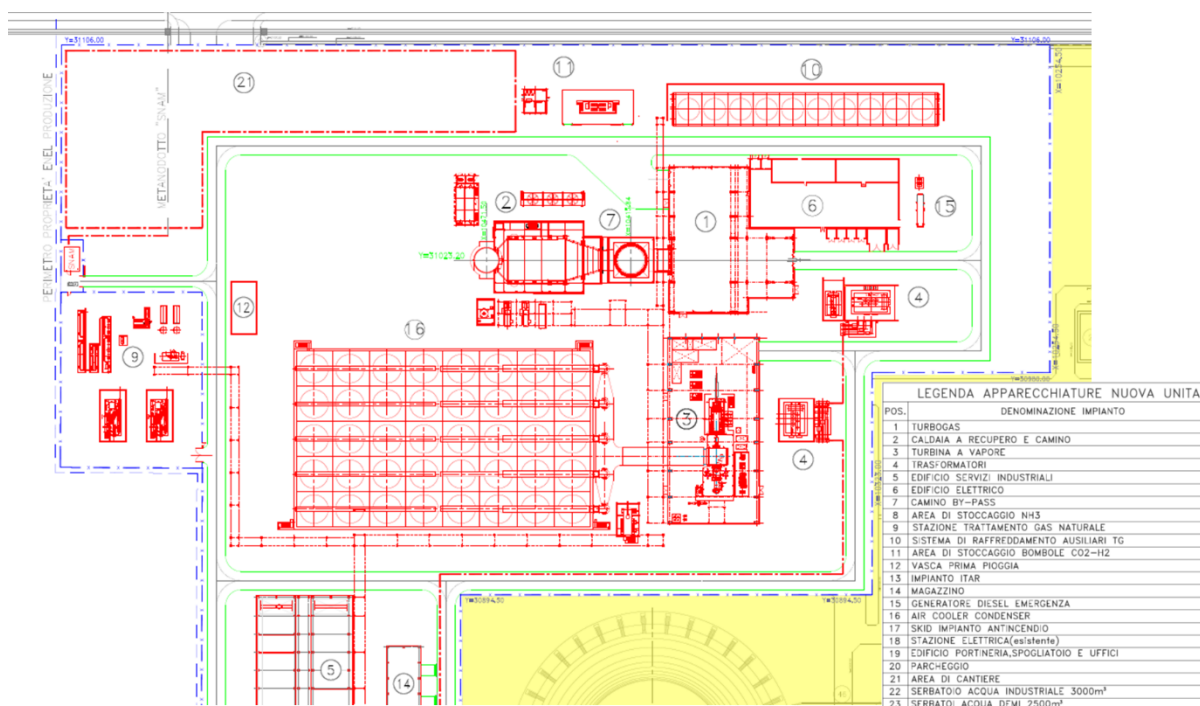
Planimetria generale dell'isola produttiva
